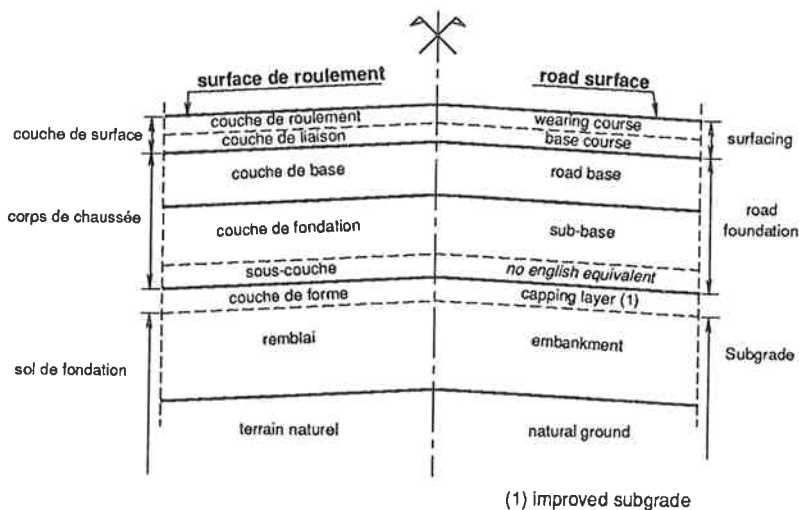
Coupe type de chaussée (AIPCR)
